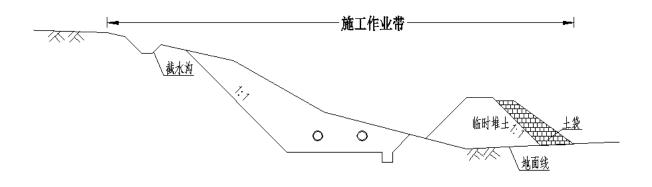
电缆沟顺坡敷设施工断面示意图
